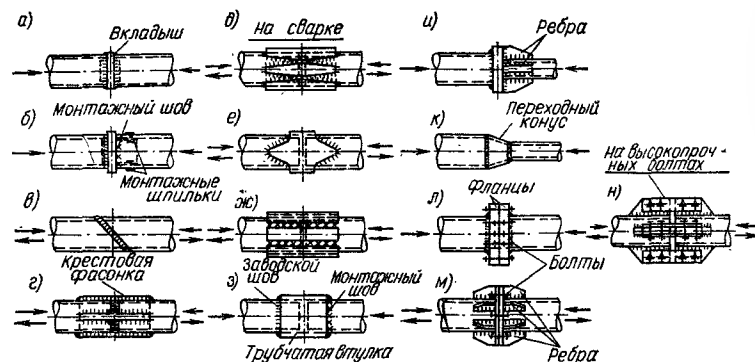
Сварные (а—к) и болтовые (л—н) продольные стыки трубчатых стержней
